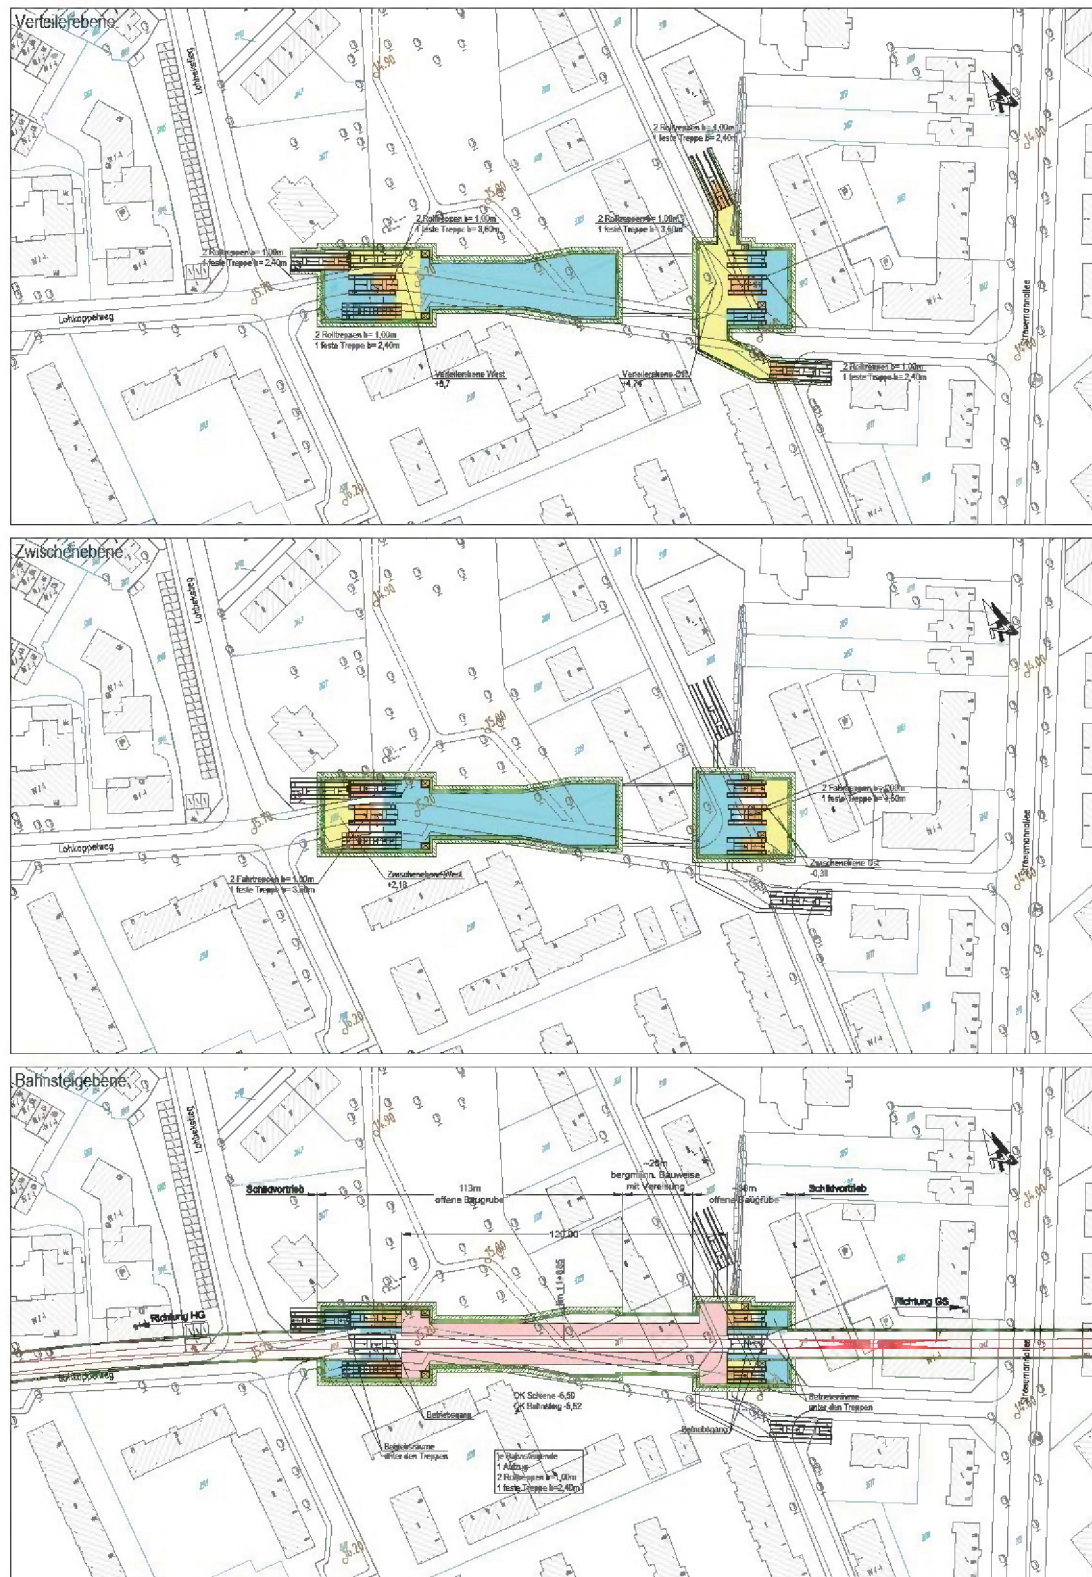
Lageplan Haltestelle Lohkoppelweg I
